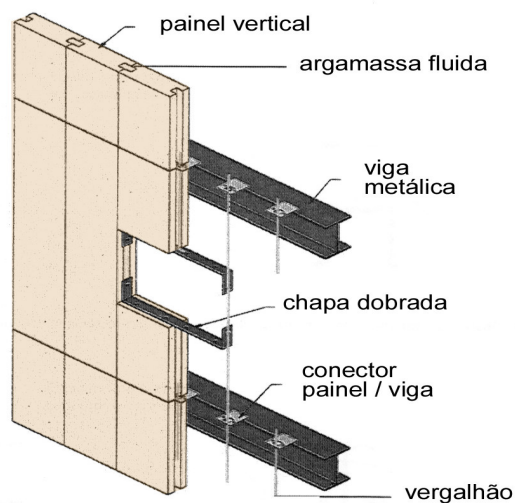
Detalhe de fixação do painel utilizando conectores. (SICAL, 1999)
